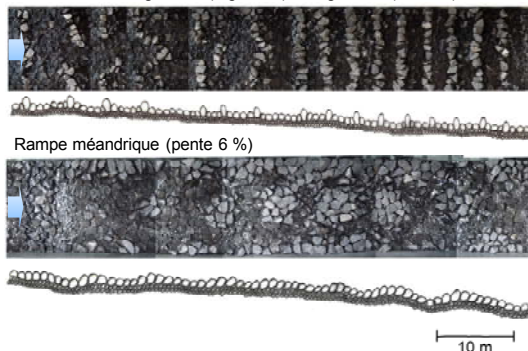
Vue en plan et profil longitudinal d'une rampe avec des traverses et d'une rampe méandrique à pente de 6 %
